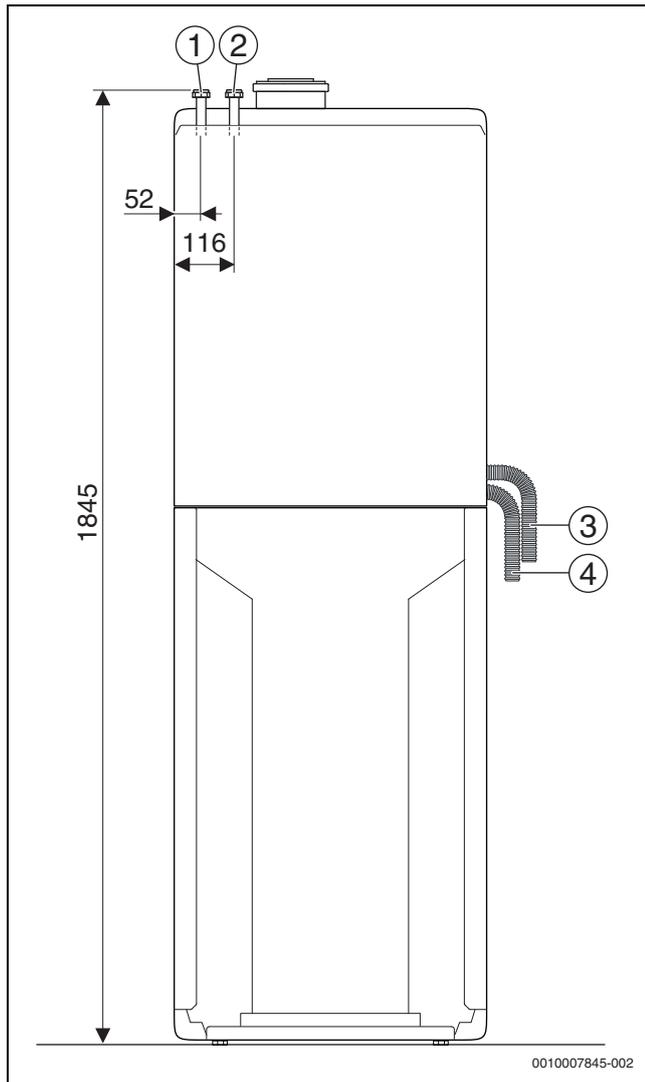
Misure di collegamento dell'accessorio Set di collegamento integrazione riscaldamento HU (misure in mm)
